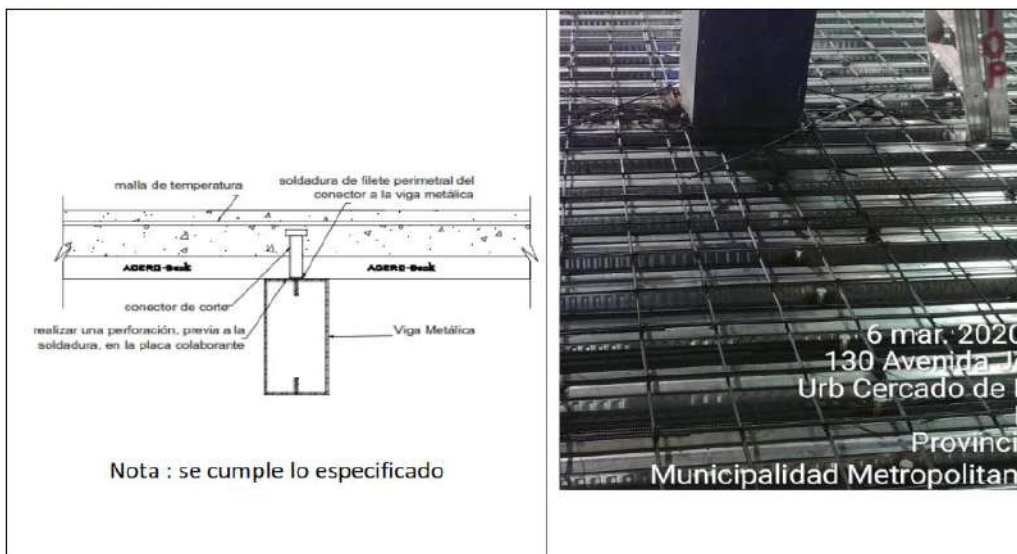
Apoyo de placa colaborante sobre viga tipo C
